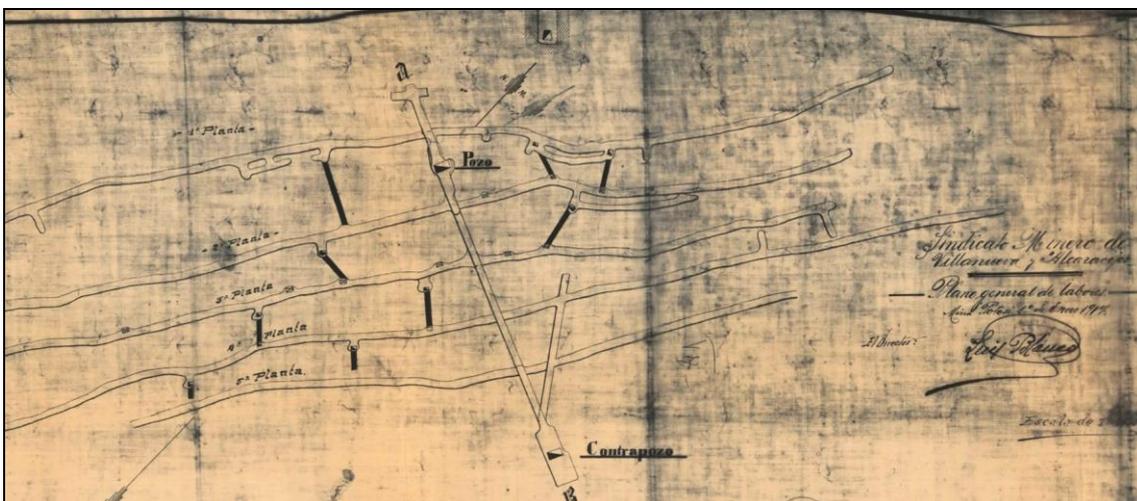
Plano de labores de la mina Potosí, 1917 (IGME)
